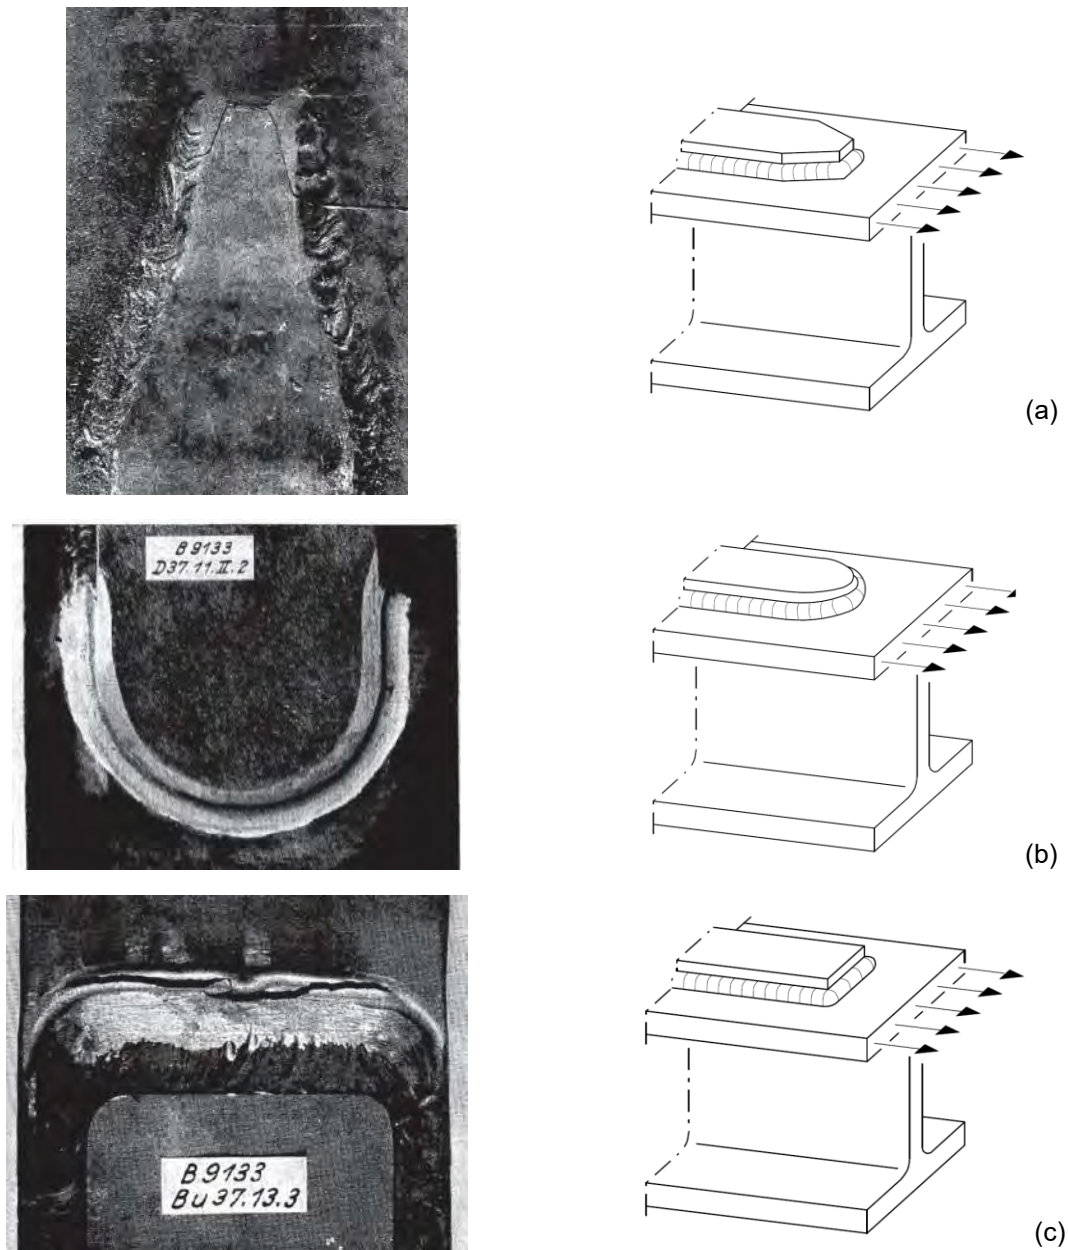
Untersuchte Endlamellenformen: zugespitzt (a), rund (b), rechteckig (c) [112]
